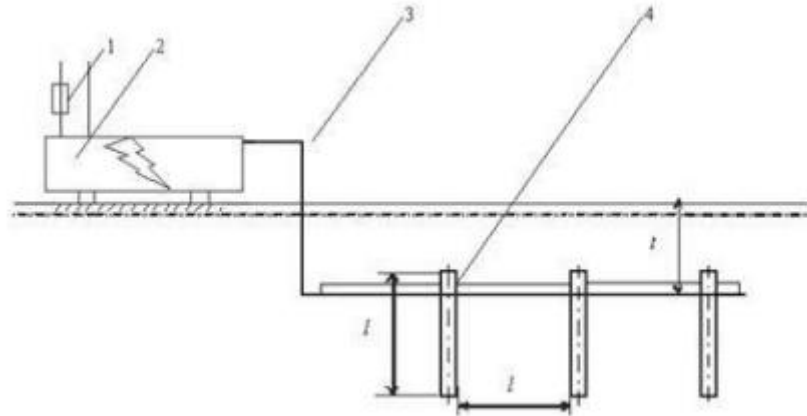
Пристрій заземлення 1 – плавка вставка; 2 – блок живлення; 3 – з'єднувальна штаба; 4 – трубчатий заземлювач
